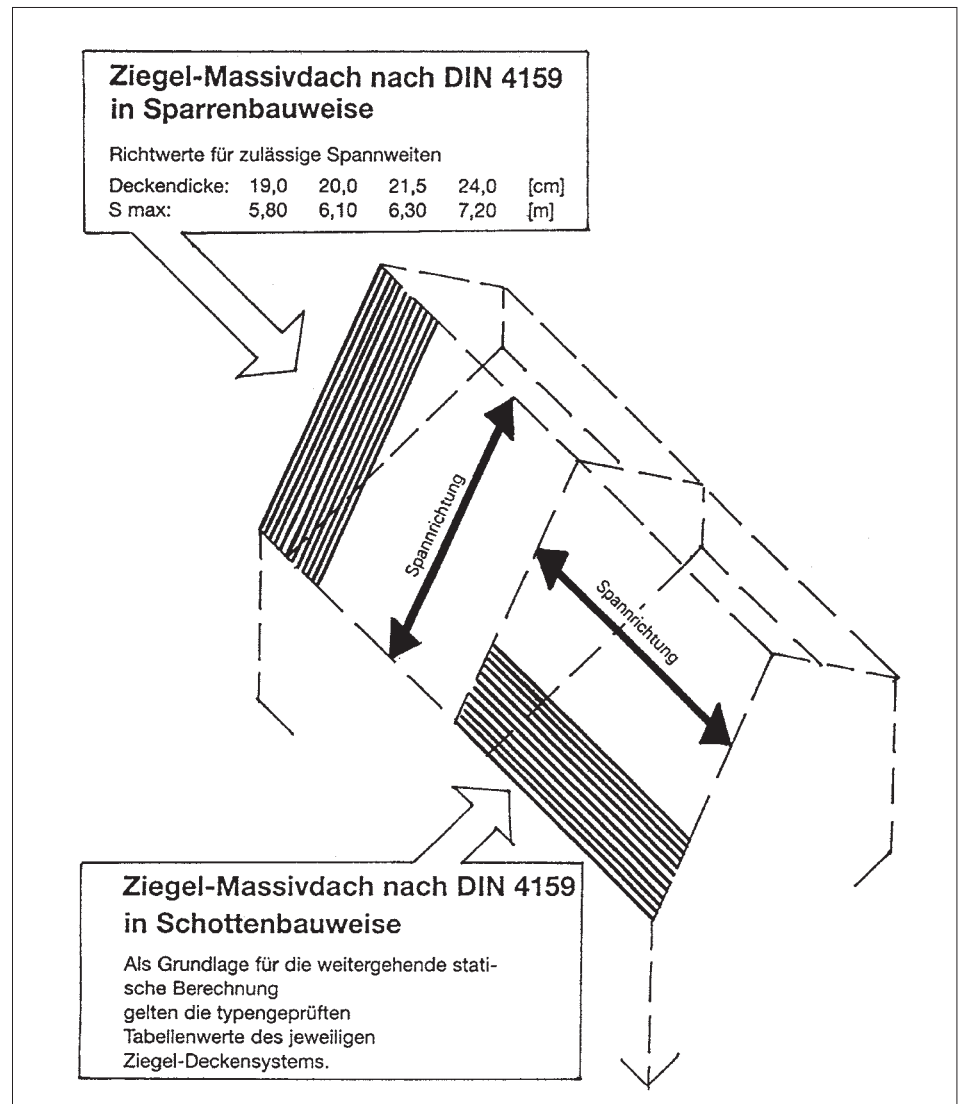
Grundsätzlicher Unterschied der Bauweise des Ziegelmassivdaches: Sparren- und Schottenbauweise [3]
